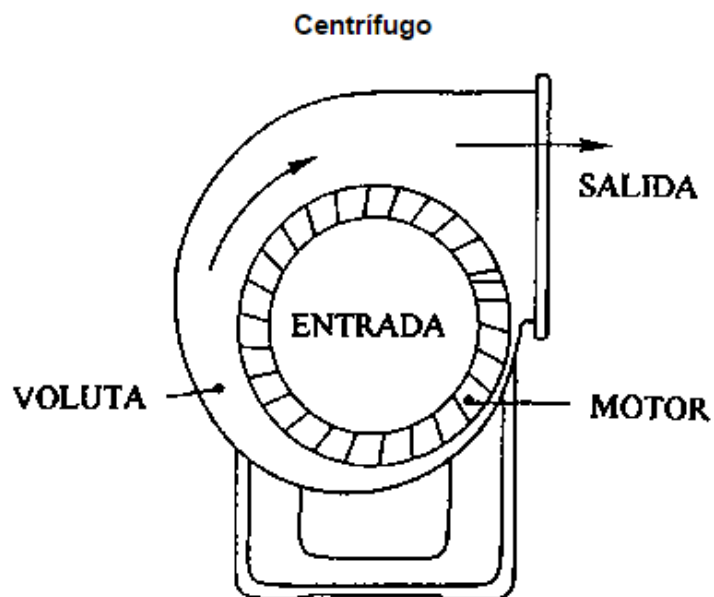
, Ventilador centrifugo– fuente: (Sutton Bridge Experiment Station, n.d.)
